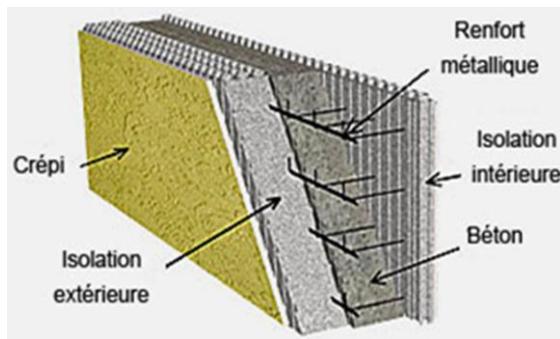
Schémas détaillé d'un mur de soutènement en béton armé
